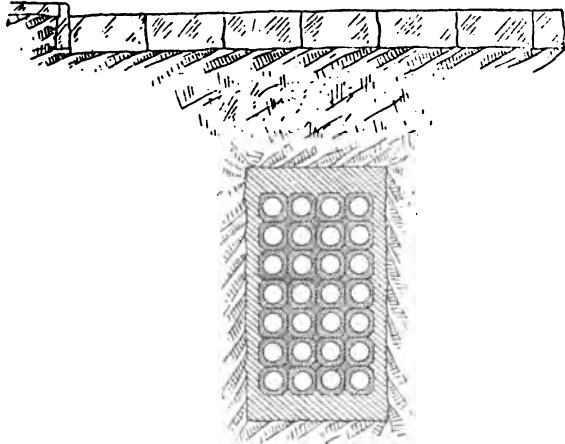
Conduits en terre vitrifiée pour câbles souterrains (Manhattan railway).
